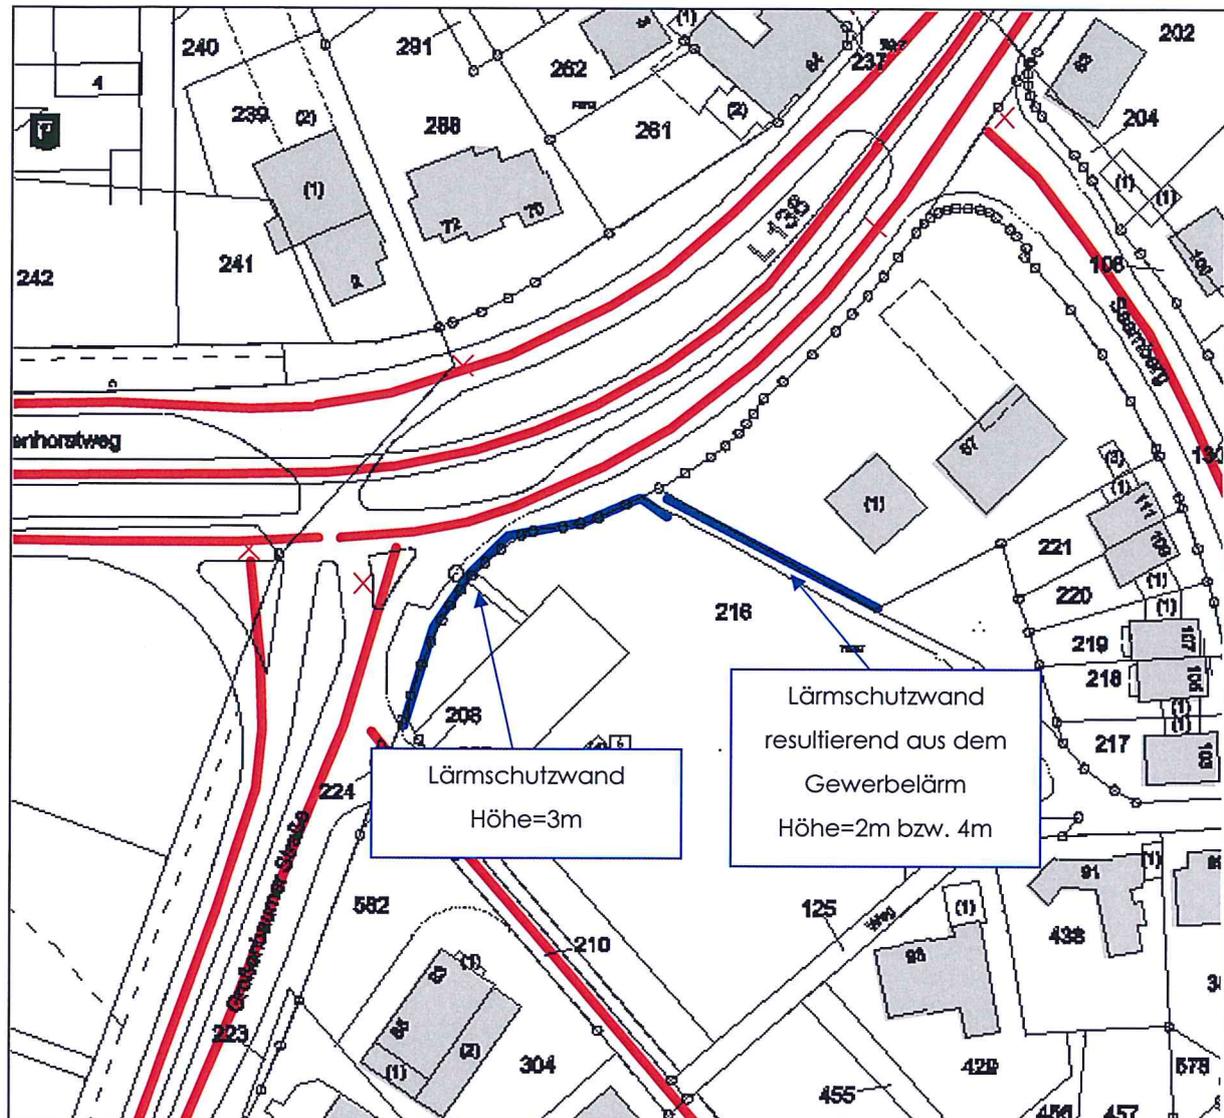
Lageplan mit Darstellung der erforderlichen Schallschutzwände (Verkehrslärm)
